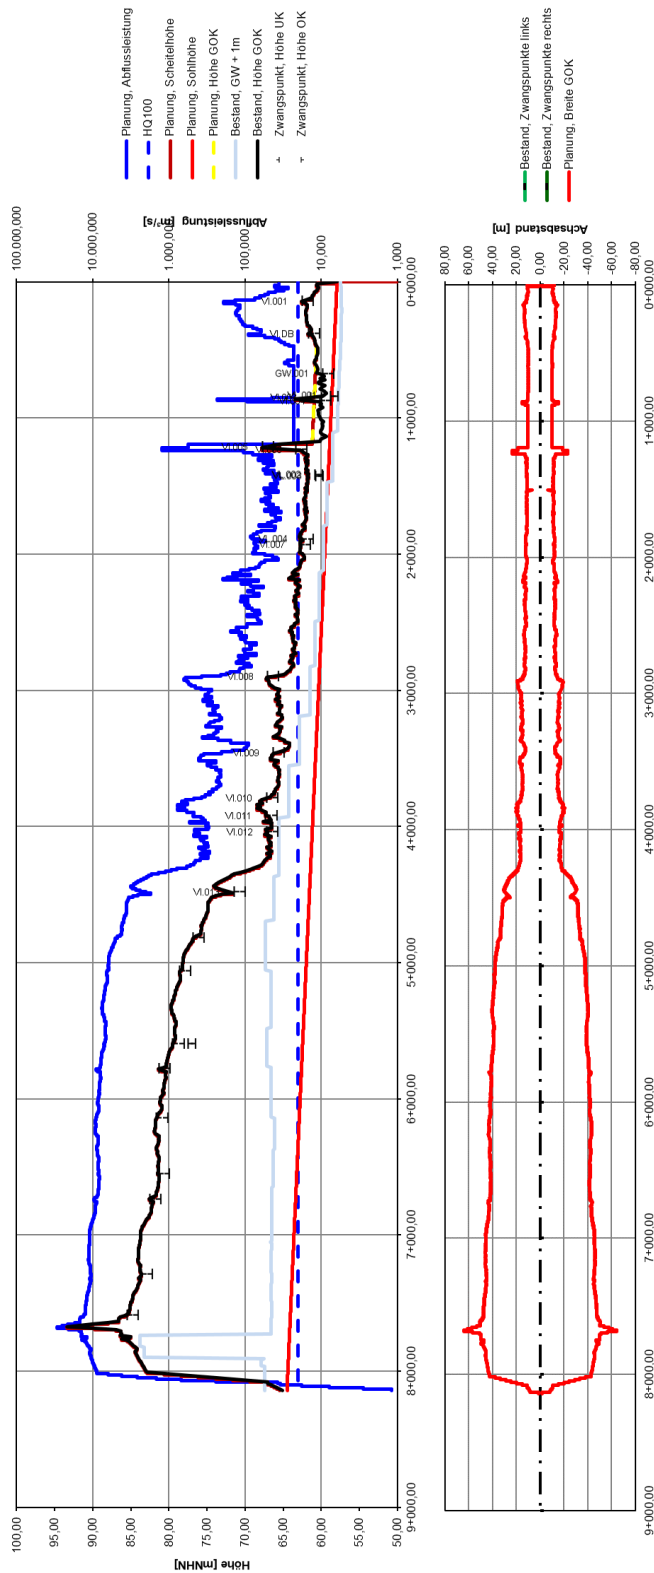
Längsschnitt (links) und Grundriss (rechts) der Variante Finkelbach (6.3) (vgl. Anlage A-5.4).
